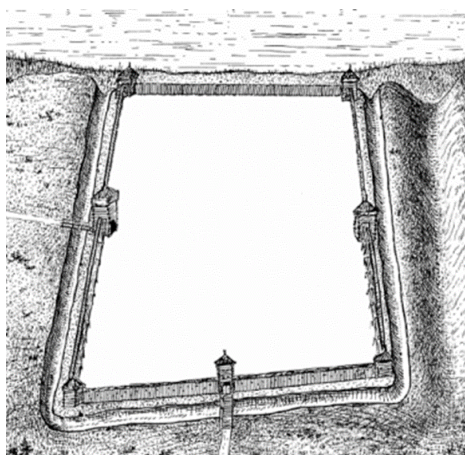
Схема укріплення з баштами і стінами з частоколу. [2]
